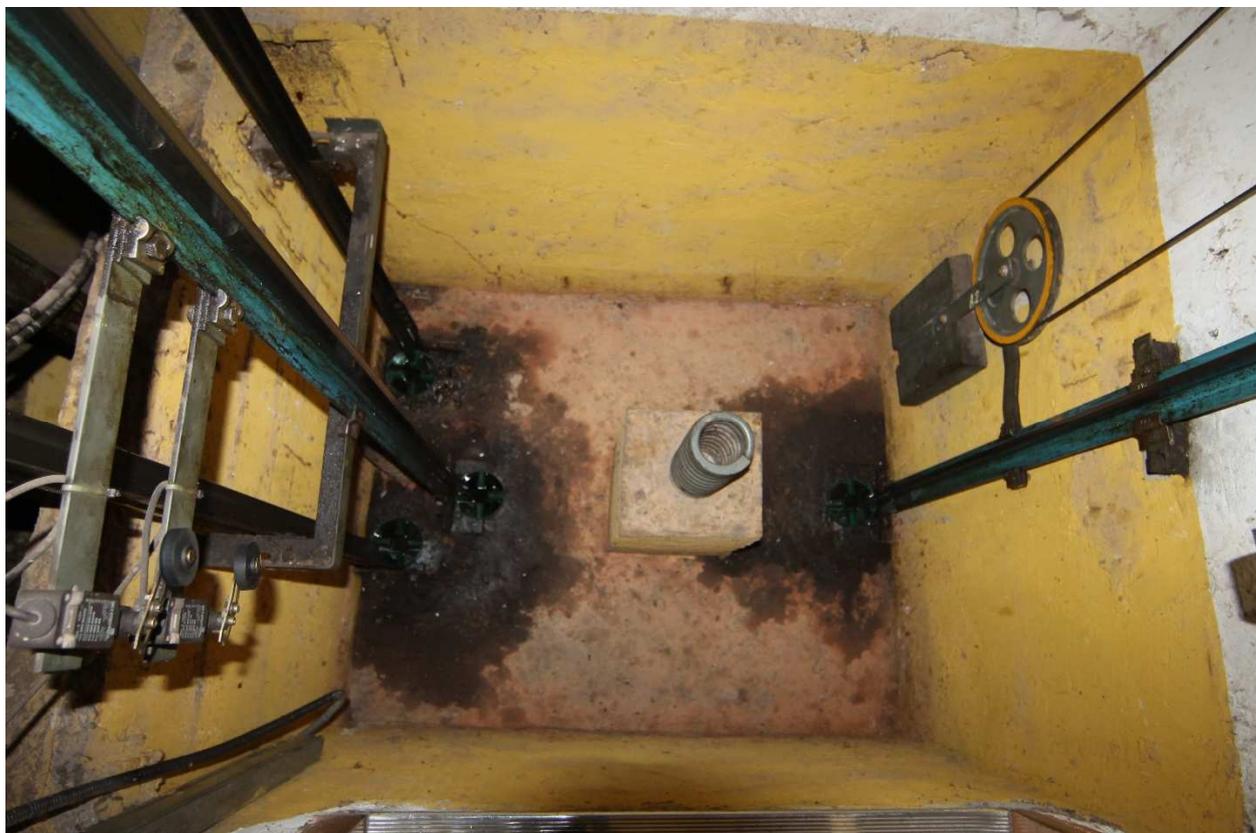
Fundo do poço dos elevadores. Adequação de iluminação, área de segurança e escada, conforme normas vigentes aplicáveis.
